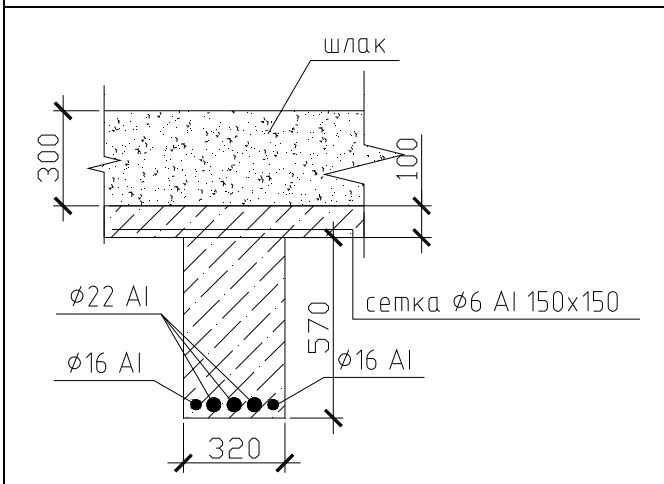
Главная балка ж/б перекрытия над пятым этажом в осях «3-7/ В-Е»
